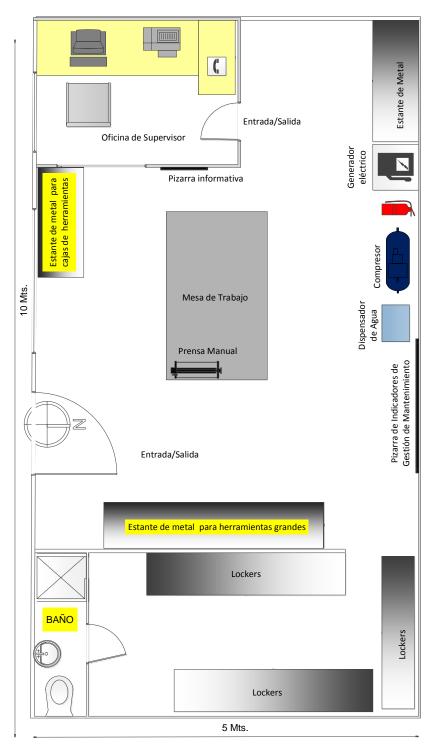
Área sanitaria propuesta para taller industrial y soldadura
